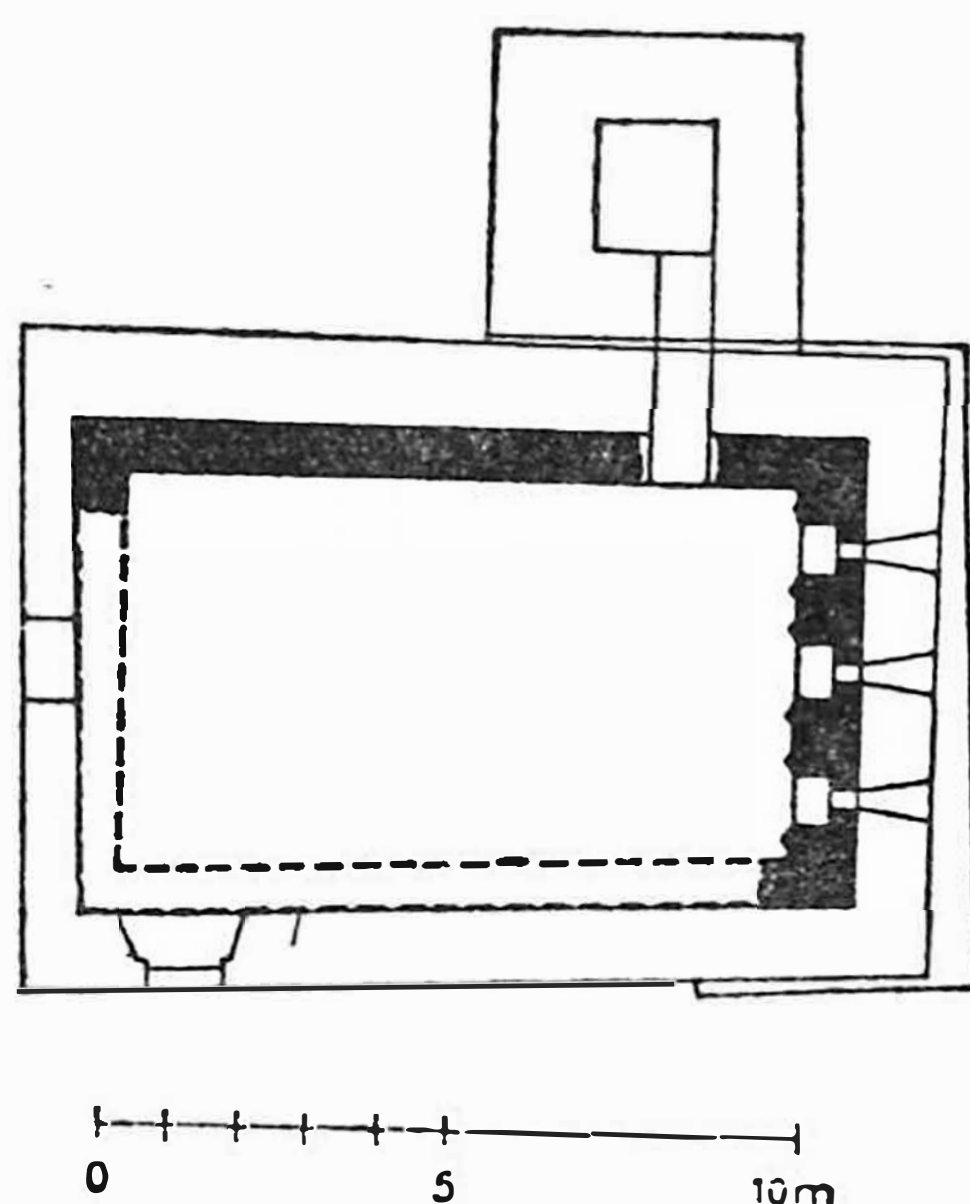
Malles. S. Benedetto, pianta (da *Vorromanische Kirchenb.*).
